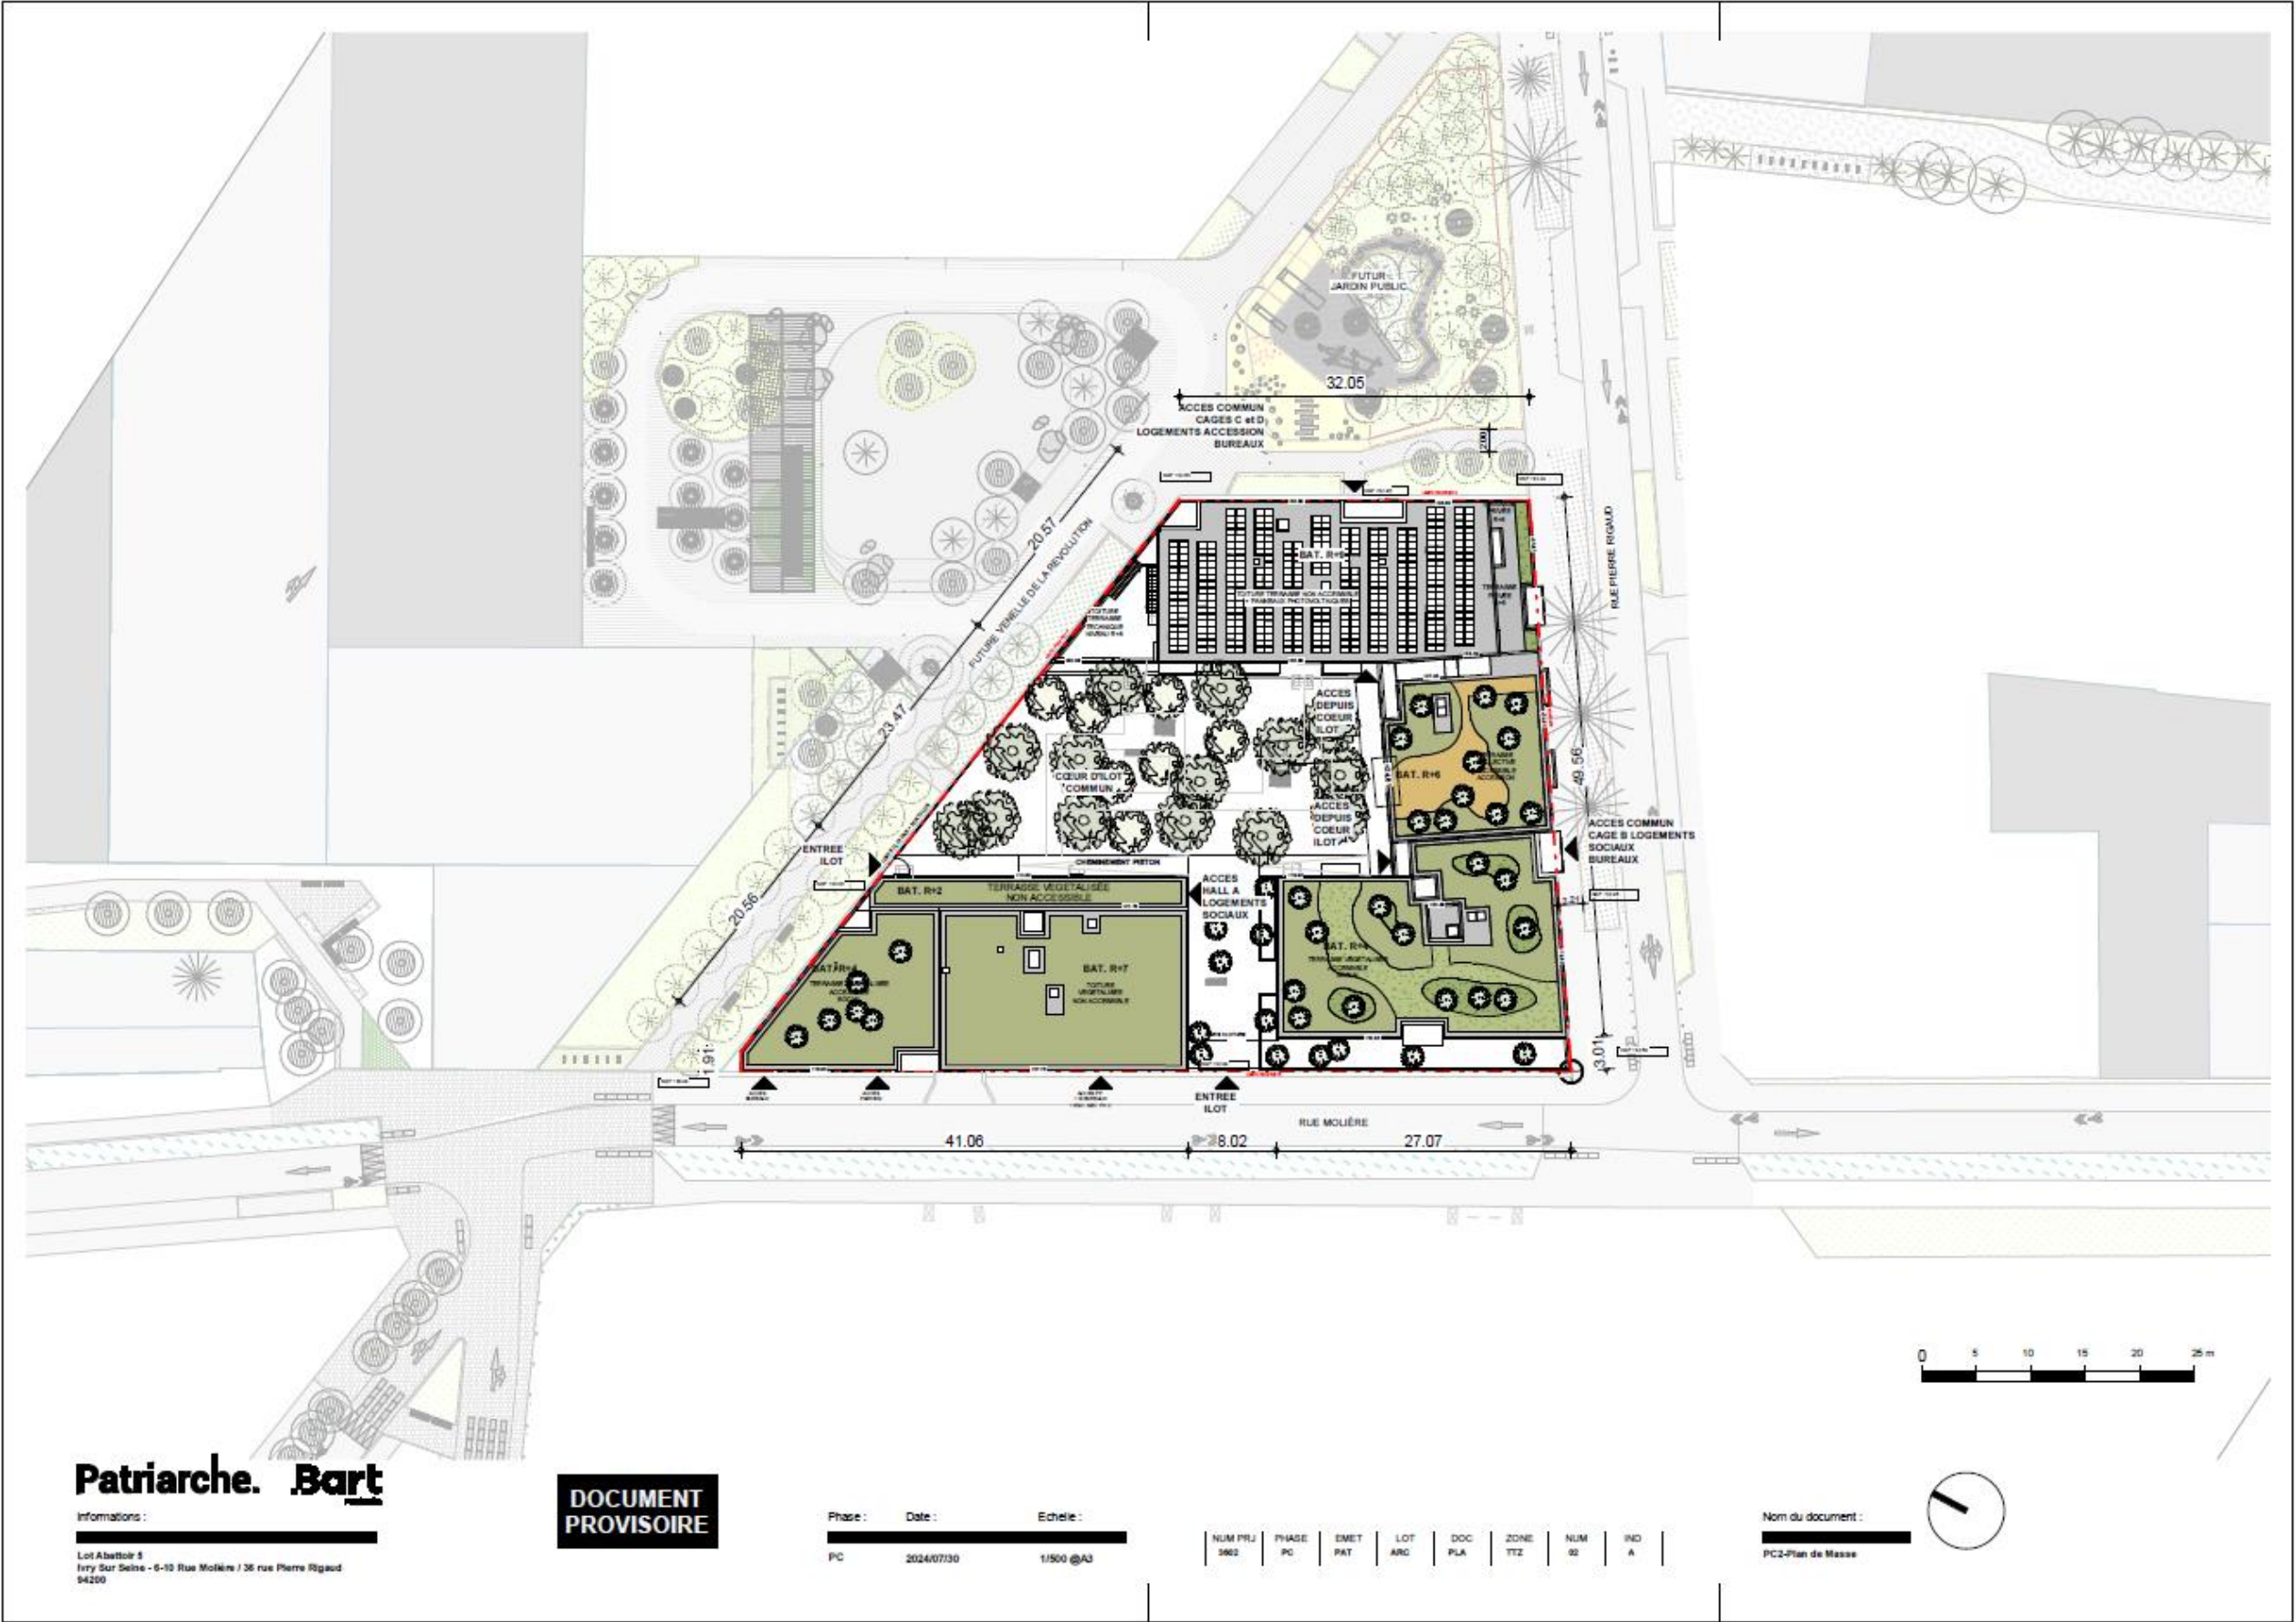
Plan masse du projet (Source : Plan du pré PC, Bart, juillet 2024)
